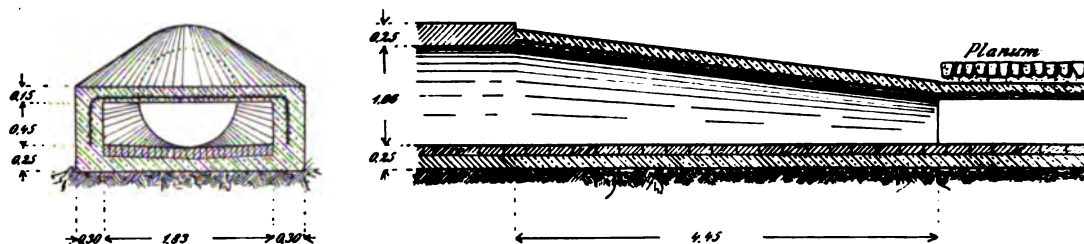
Kreuzung des Hauptkanals von New Jersey mit einer Eisenbahn. 1:80.
